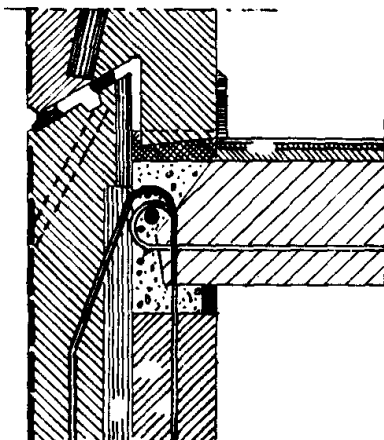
Junta horizontal de paneles de fachada y forjado. Sección vertical.
